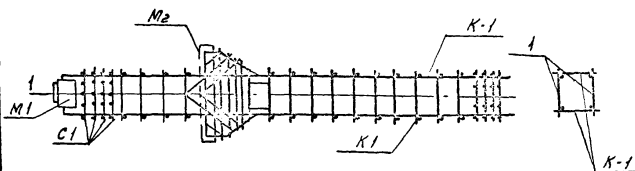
Конструкция обвешного каркаса свариваемого подвесными машинами К-2433 и МТГ-1601
